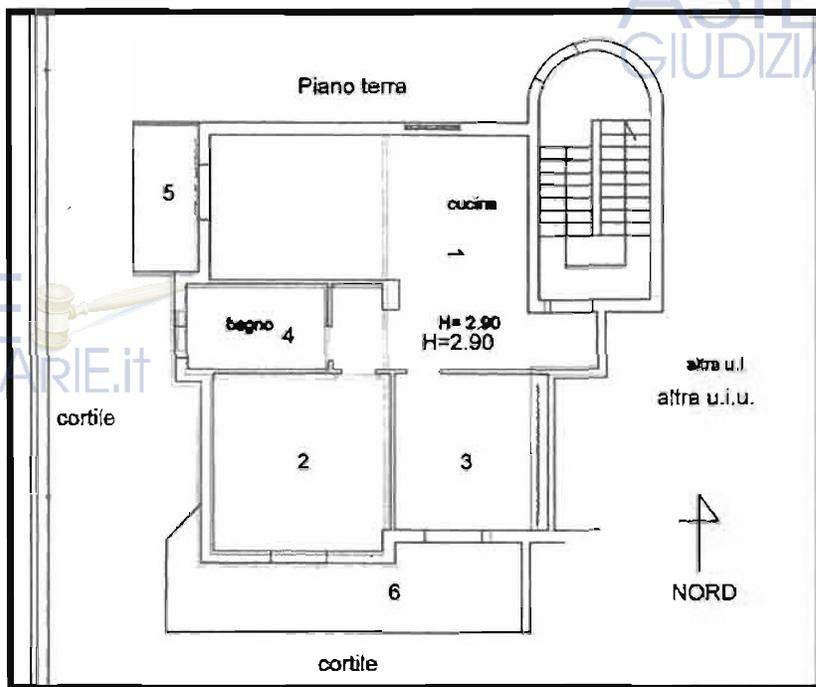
Sovrapposizione Planimetria Stato Attuale - progettuale
